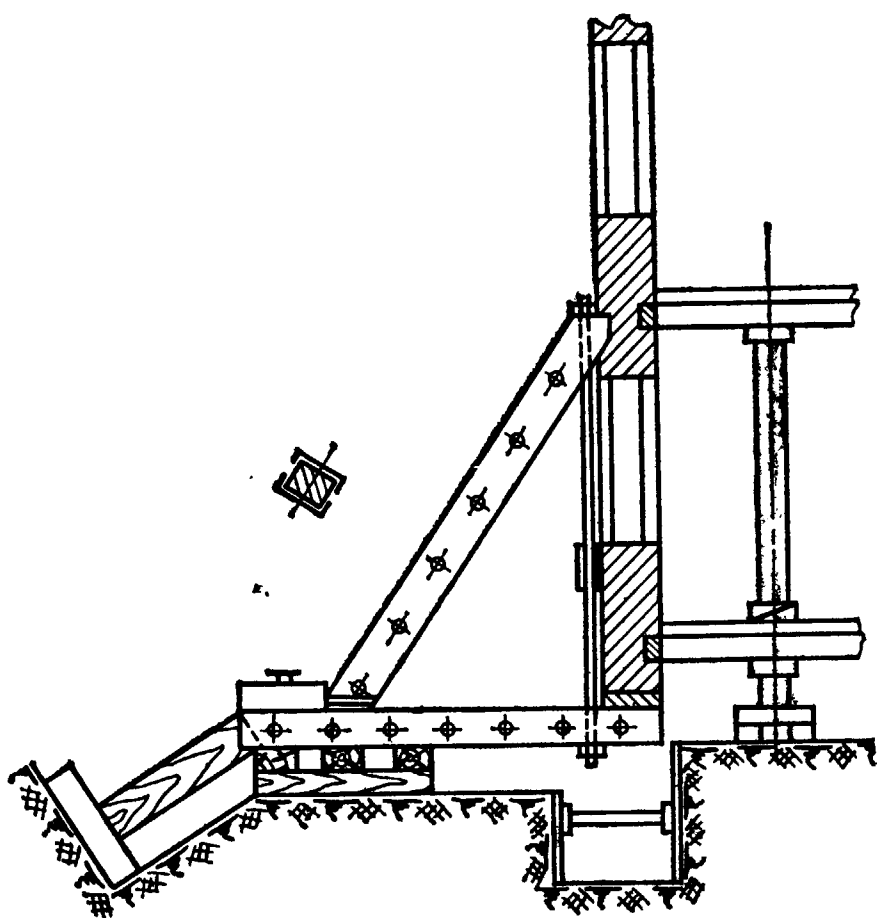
Вывешивание стен здания с помощью односторонних подкосов
